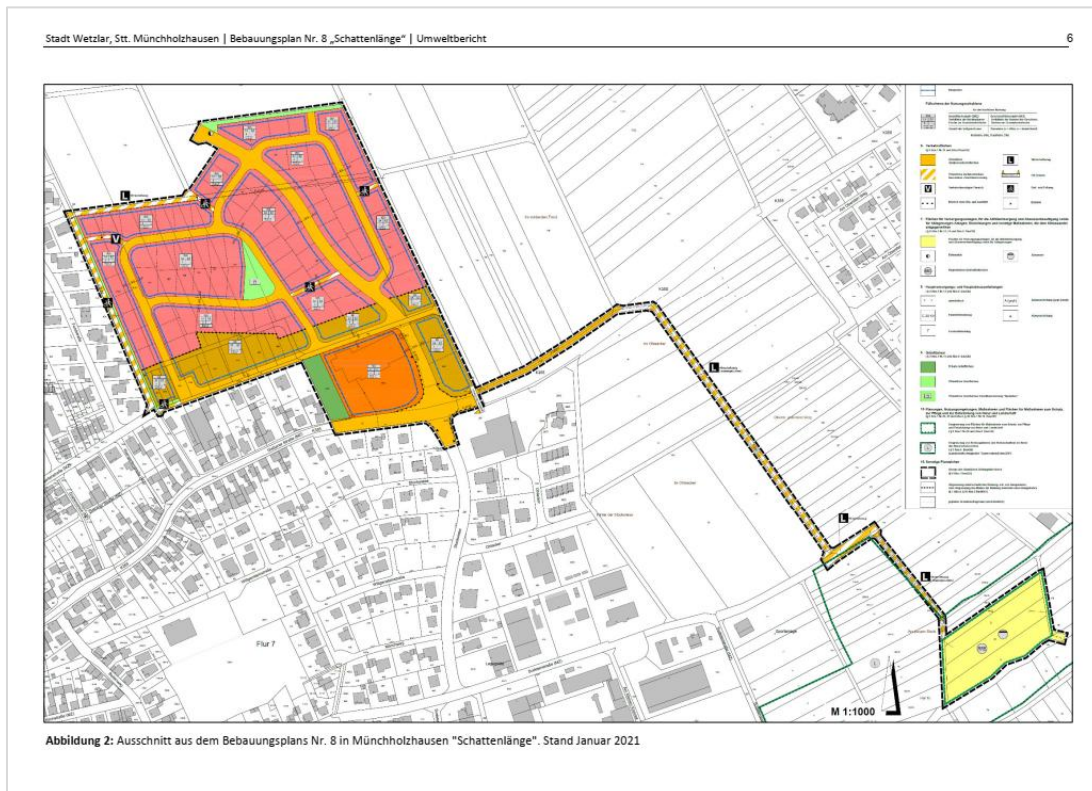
Bebauungsplan "Schattenlänge"
